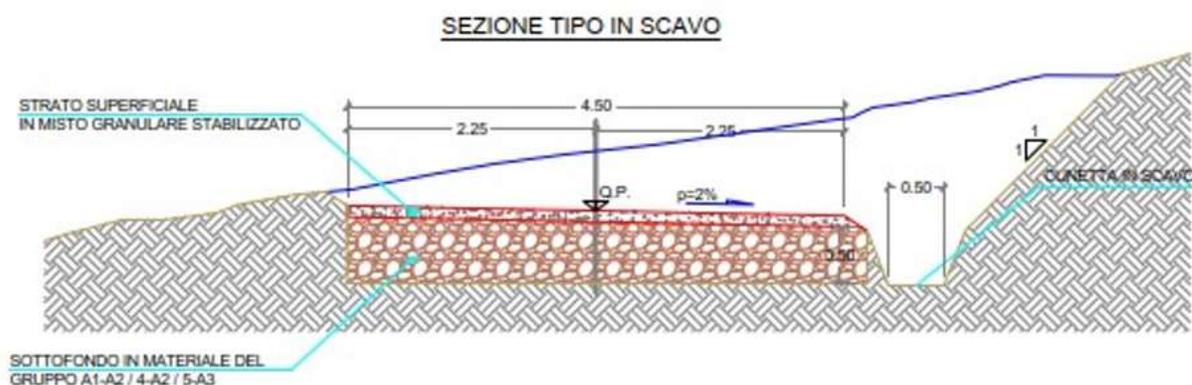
Sezione stradale "tipo" IN SCAVO della viabilità di progetto (strade di accesso alle piazzole e relativo pacchetto stradale)
